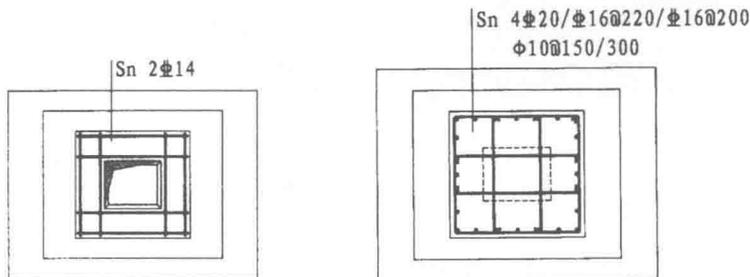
单杯口独立基础顶部焊接钢筋网示意
